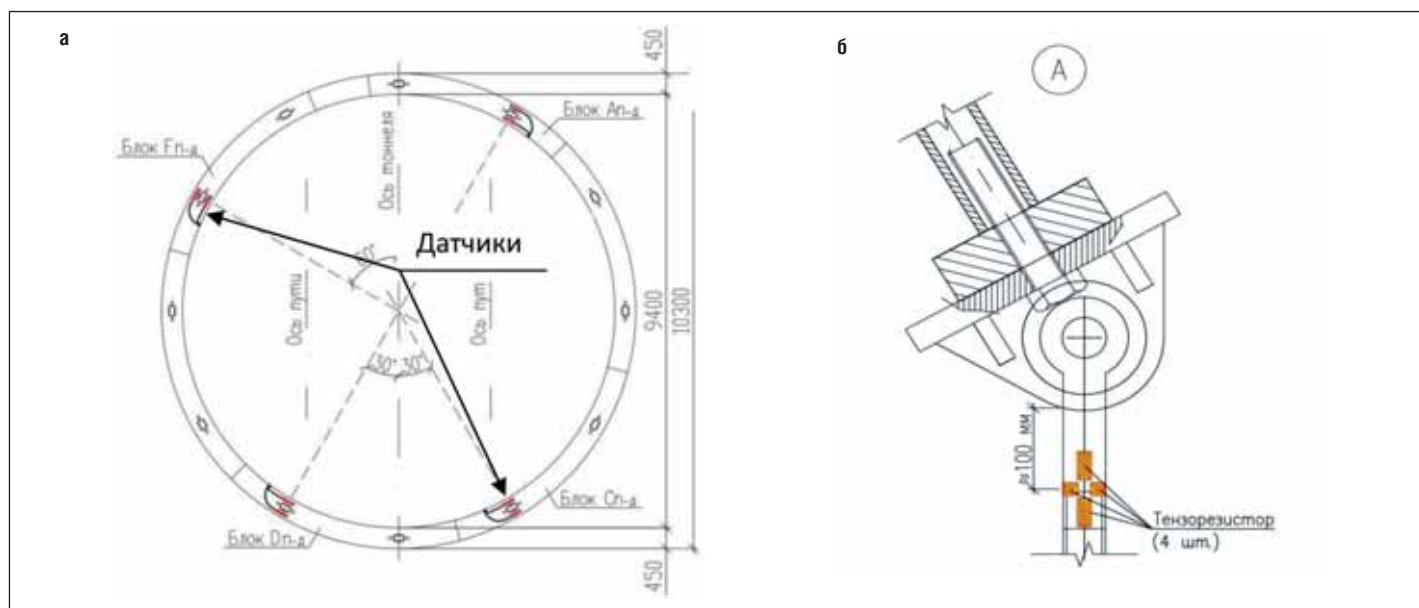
Схема размещения датчиков: а – в обделке двухпутного перегонного тоннеля; б – на тягах подвешного перекрытия
